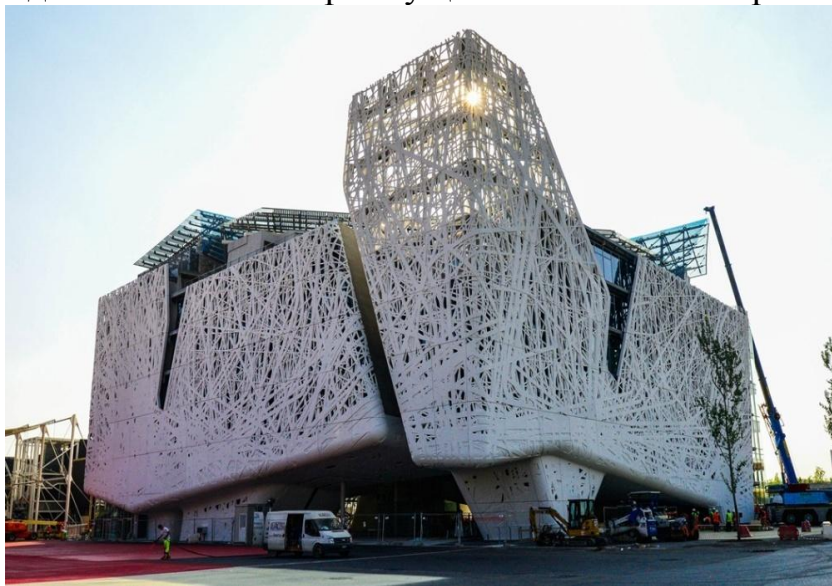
Поглощение смога зданием с использованием биодинамического бетона
